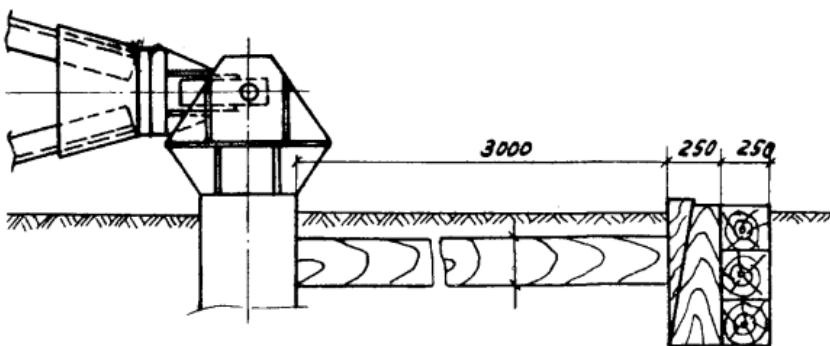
Узел раскрепления фундамента от сдвига при установке опор типа ПН-750.
